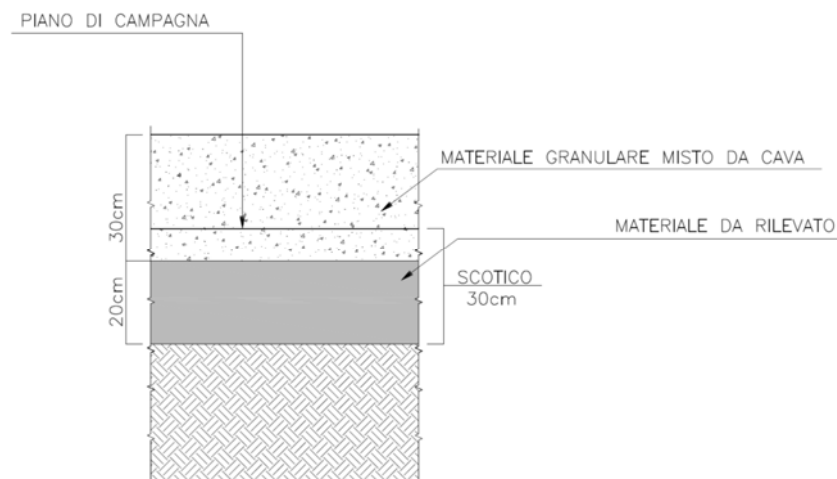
Pacchetto di pavimentazione nell'area di stoccaggio
